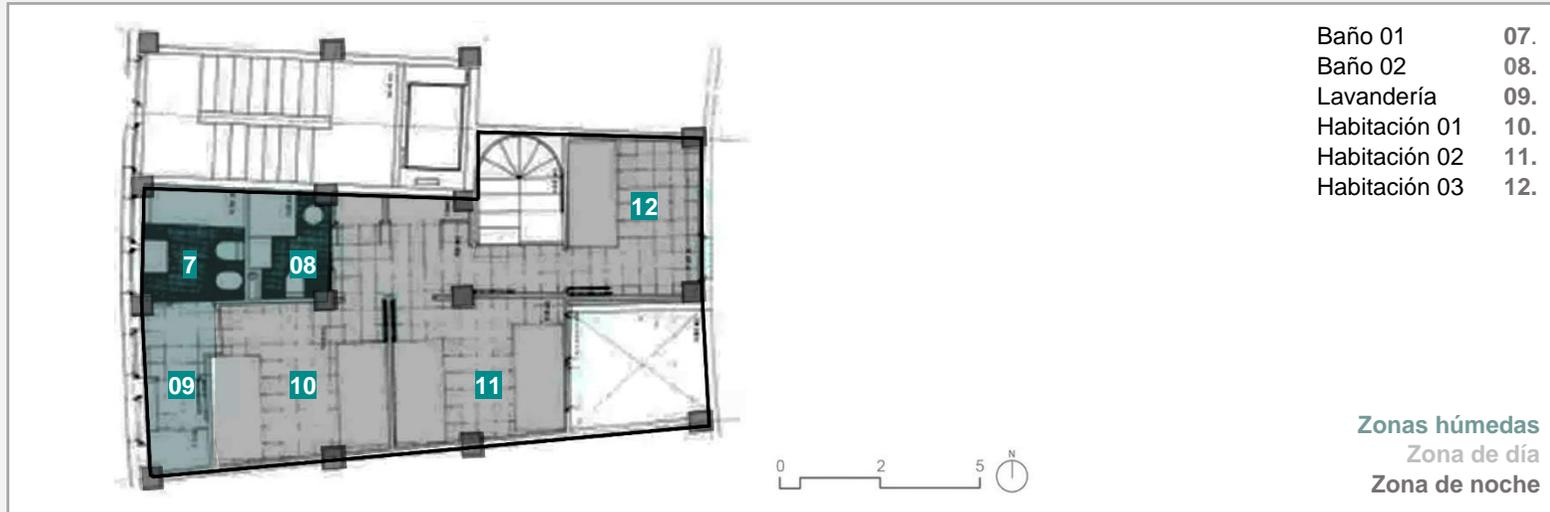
El Ruedo. Planta tipo 3 dormitorios. Planta Primera
